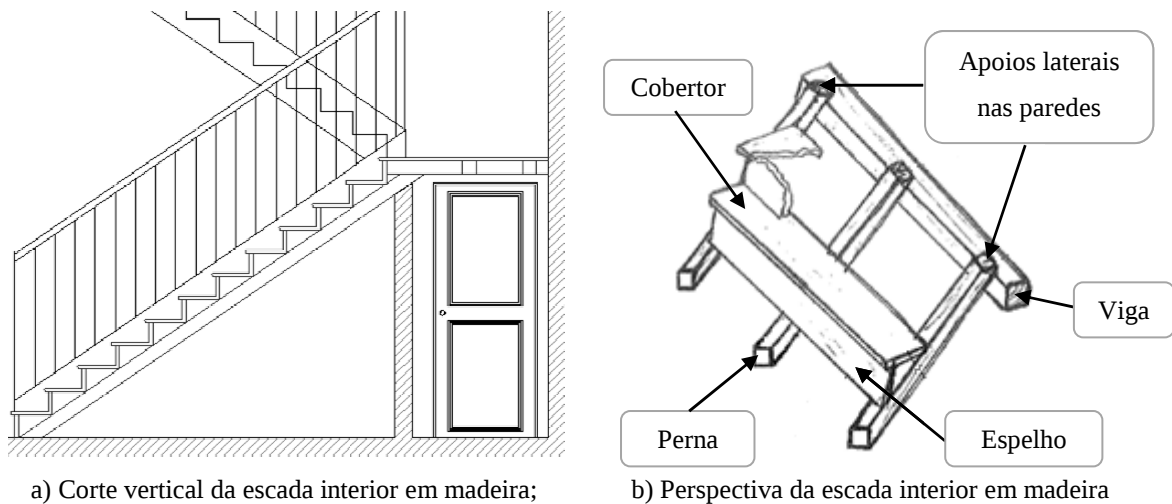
Pormenor construtivo da escada de madeira interior, que dão acesso ao sótão.
